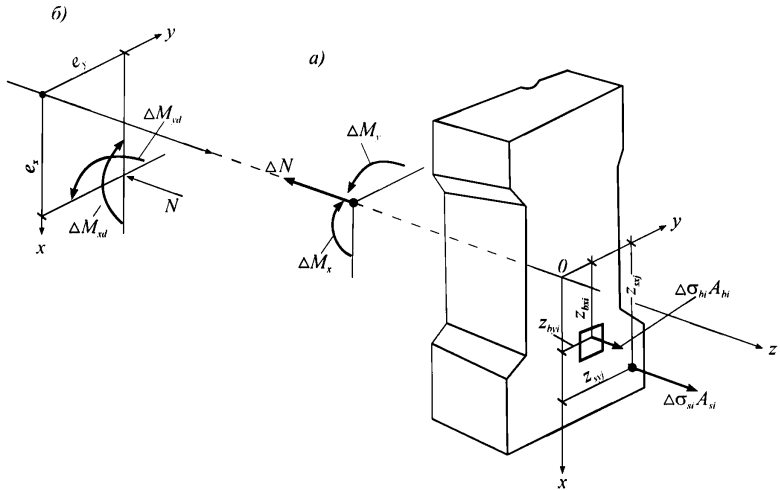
Расчетная схема нормального сечения железобетонного элемента в приращениях
